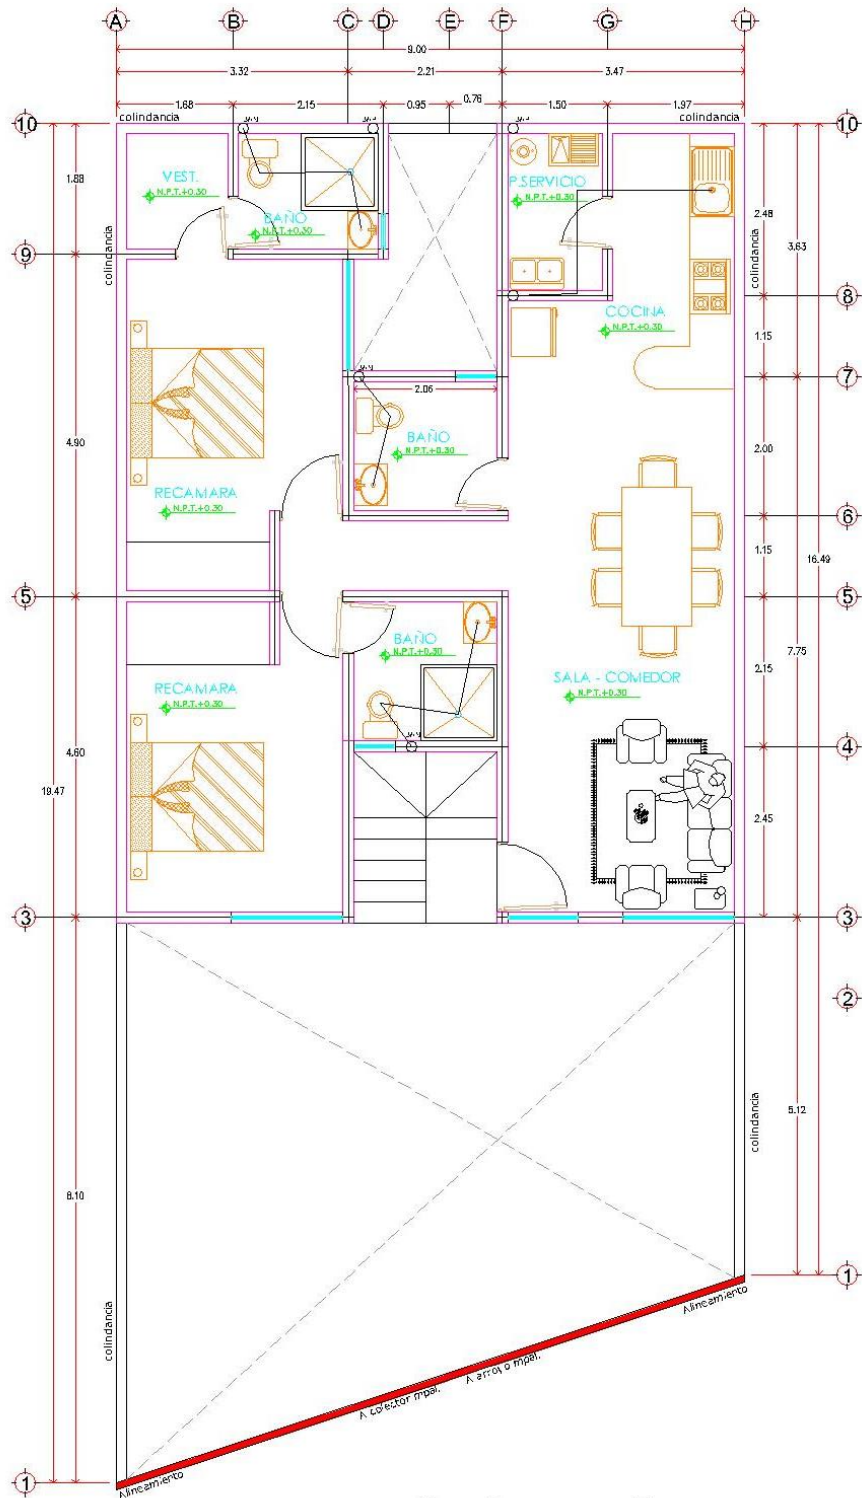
Planta baja arquitectónica. Fuente: Análisis y diseño estructural (2021)
